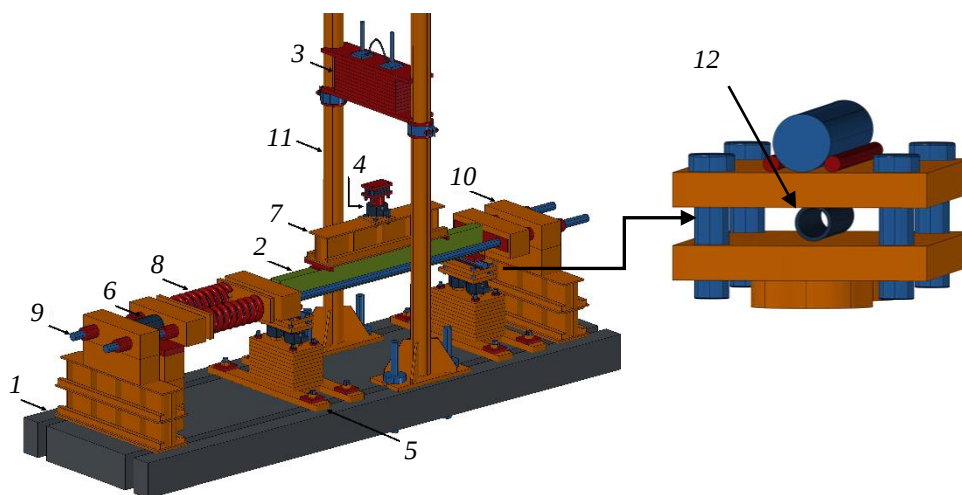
Схема стенда для испытаний сжатых конструкций поперечной кратковременной динамической нагрузкой:
